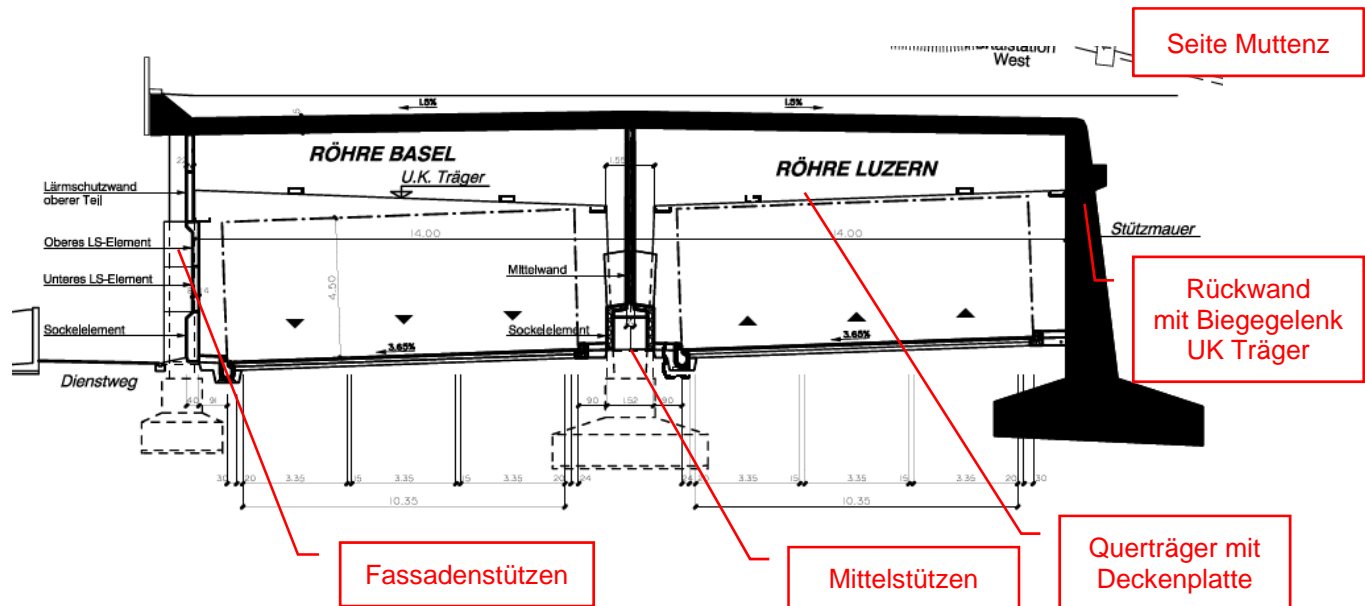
Tunnelquerschnitt mit Bauteilbezeichnungen
